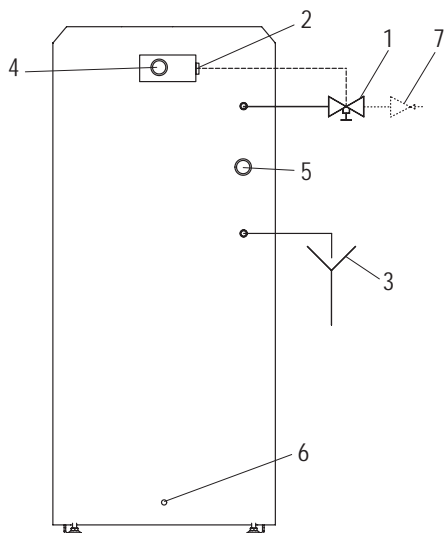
Collegamento della batteria di sicurezza - vista da dietro
